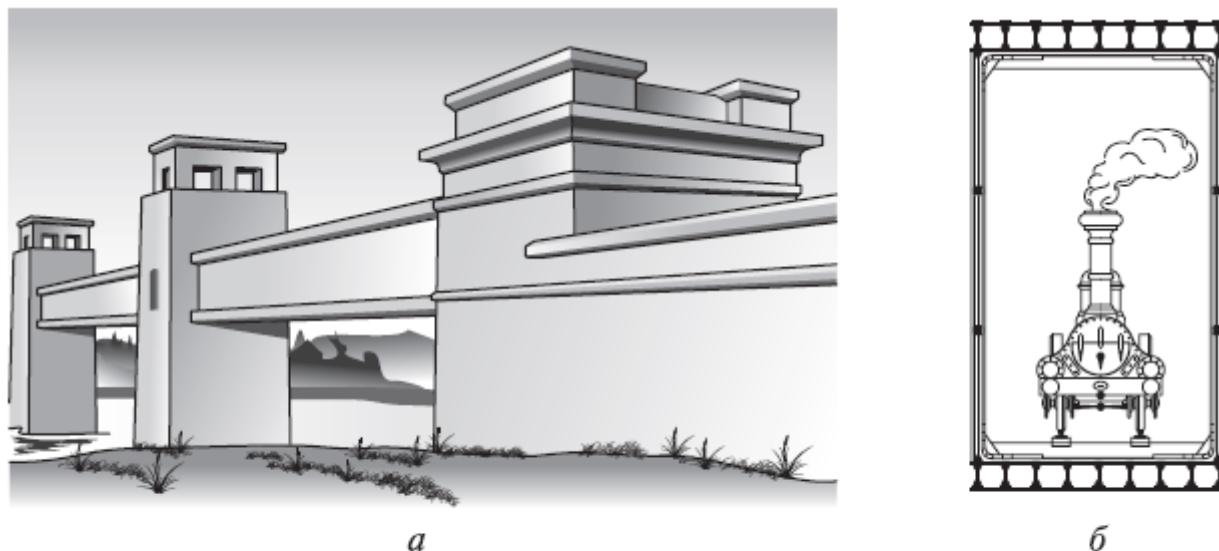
Общий вид (а) и поперечное сечение пролетного строения (б) моста «Британия» (1850 г.)
